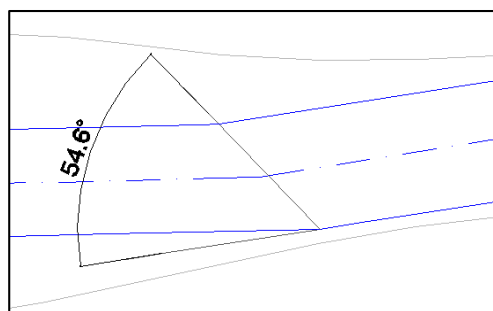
Aplicación al diseño en plano "3.2. Planta"
